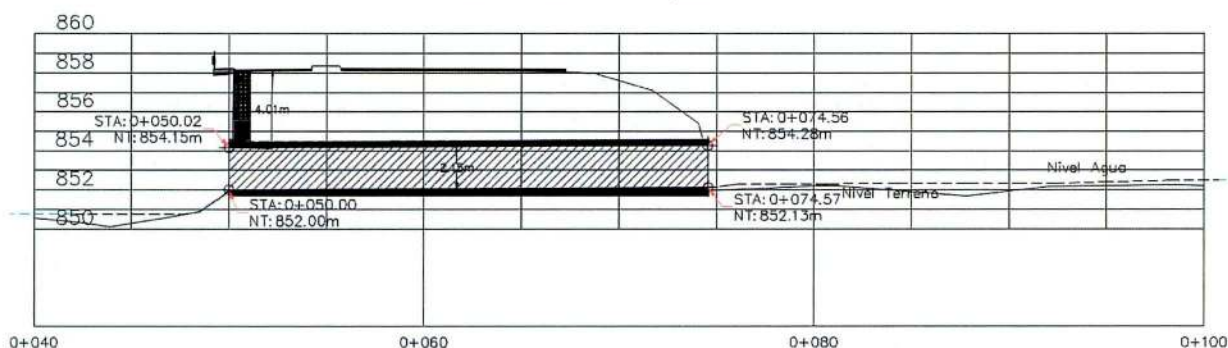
Perfil de la alcantarilla actual en la Quebrada Pilas
